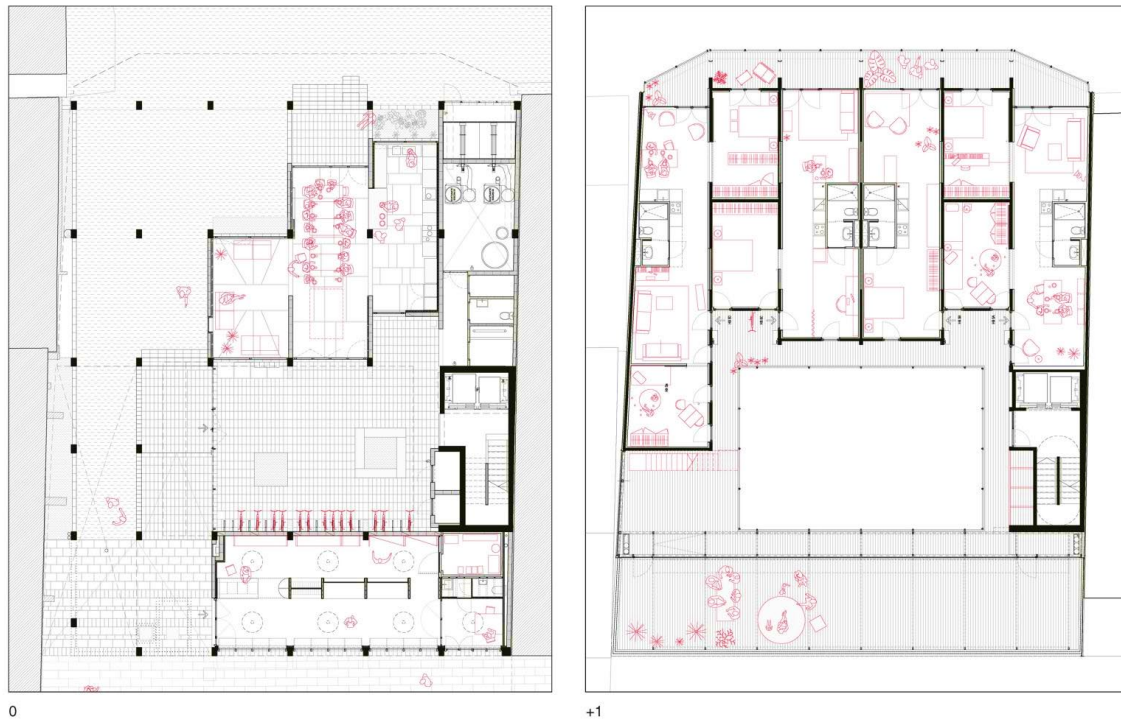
Planta baja y planta piso del proyecto La Borda. Espacios comunitarios y viviendas.
